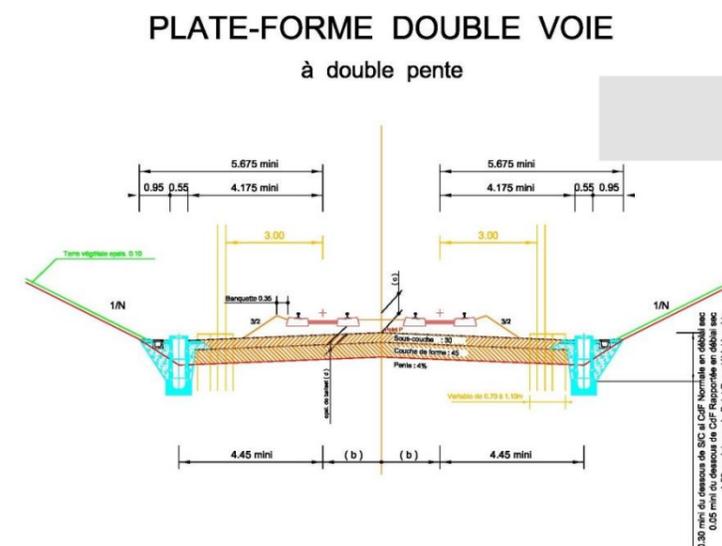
Profils en travers type en déblai avec fossé béton préfabriqué à barbacanes (FBPB)
